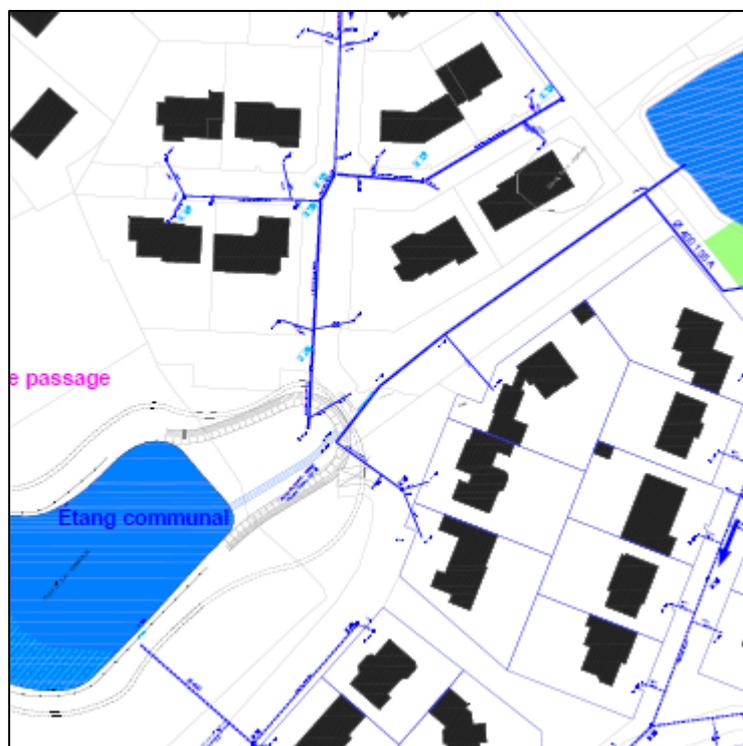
Extrait du plan n des eaux pluviales (plan en annexe)
